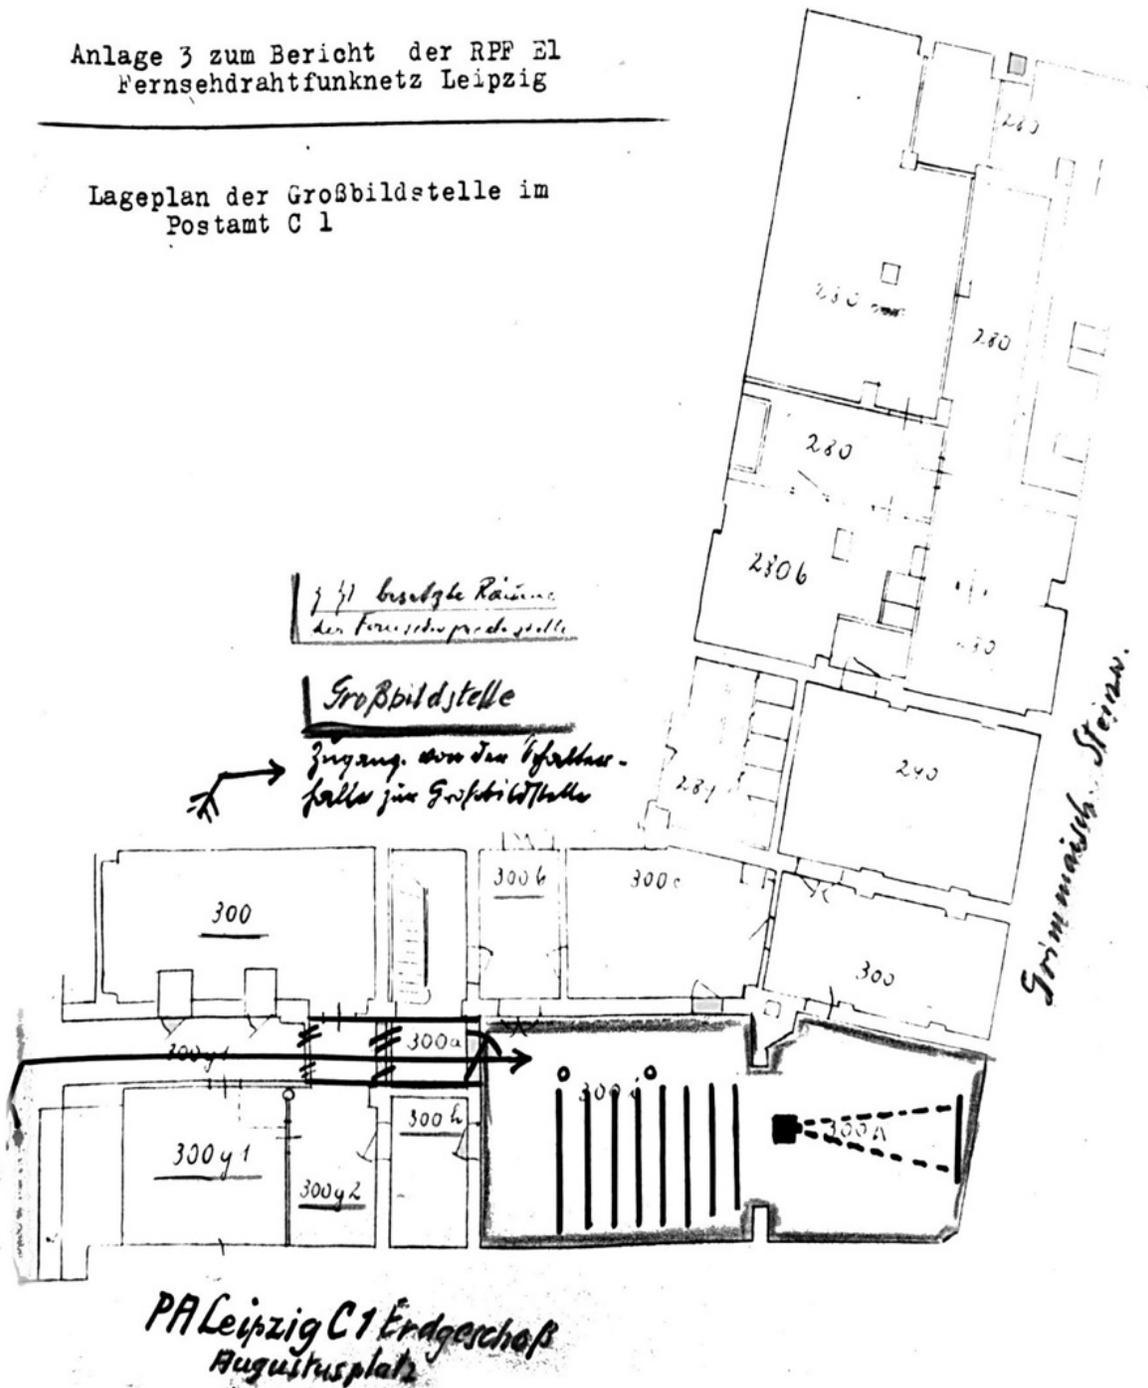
Lageplan der Großbildstelle Leipzig (Bundesarchiv R4701-13064)
